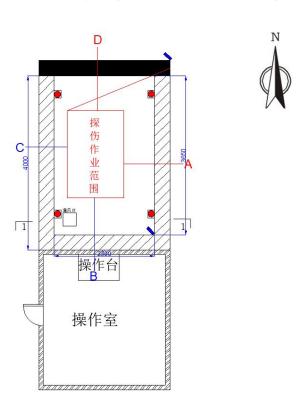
(a) X 射线探伤机在探伤室内探伤作业范围示意图 (平面图,单位:mm)
